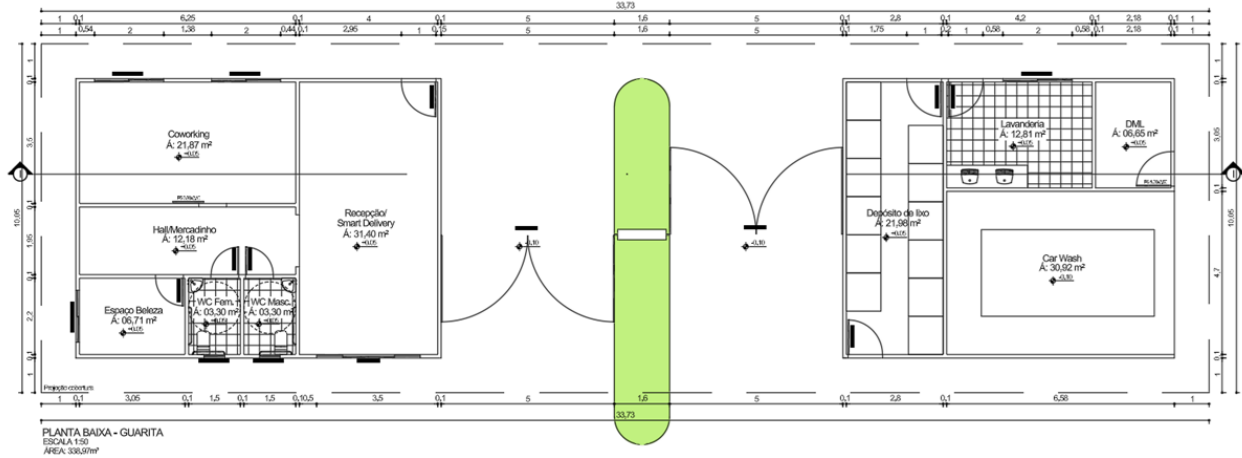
Planta da guarita. Fonte: LM5 Construtora
